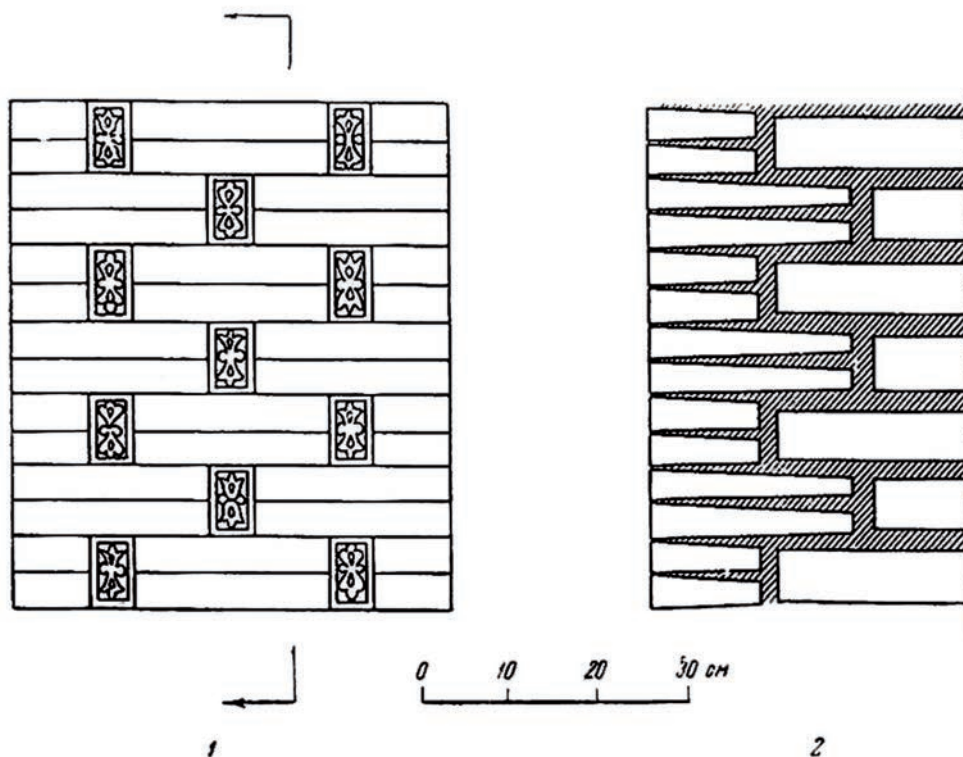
Крепление облицовки к массиву стены: 1 – фасад; 2 – разрез. По: [Лапиров-Скобло 1958]
